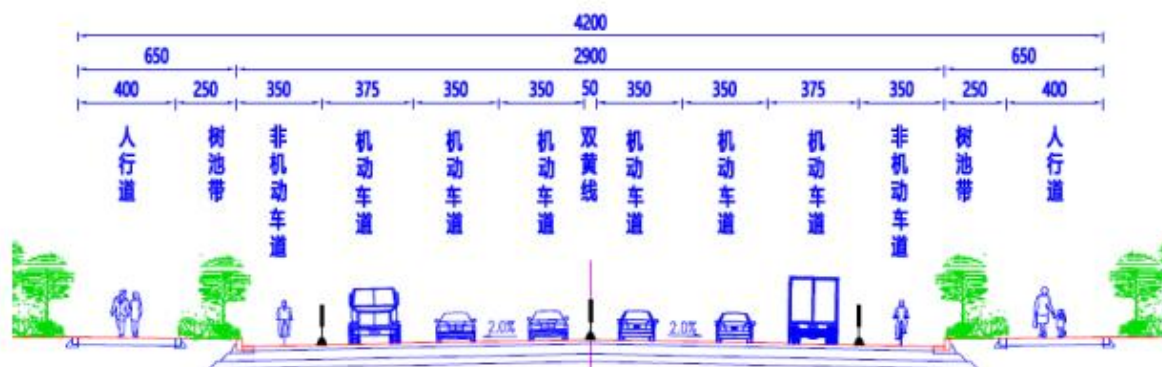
剑横路（东方东路-东方二路）横断面图 单位：m
